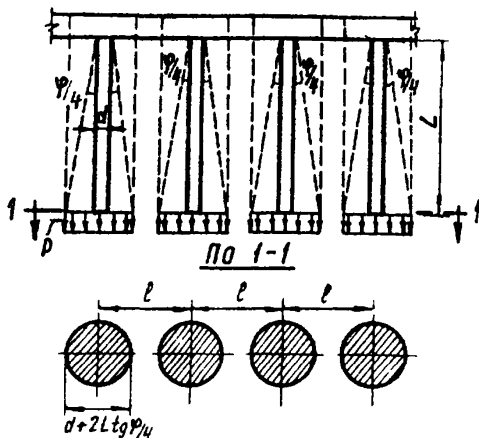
Схема к расчету осадок условного фундамента при очередном расположении свай, когда круговые площадки не накладываются.
